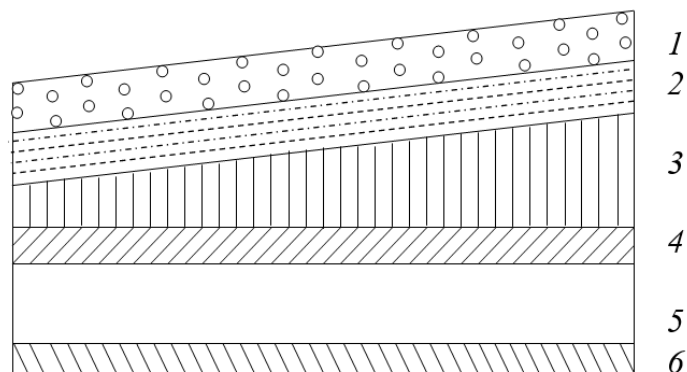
Coupe verticale du plancher terrasse (dalle pleine)
